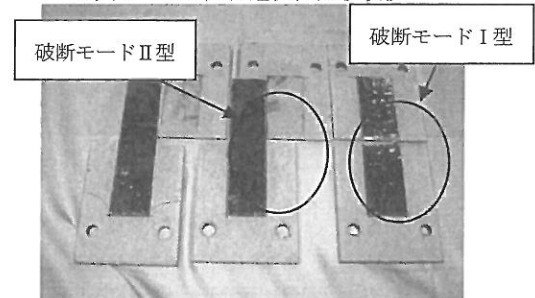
ひび割れ追従性試験実施後の試験体の状態
